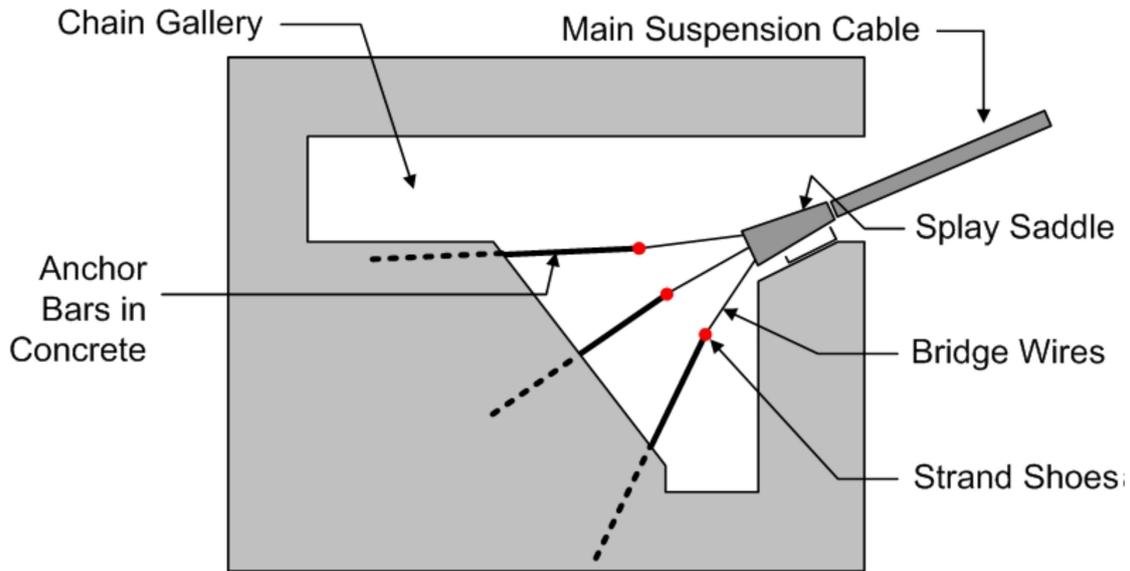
圖 H 主纜索錨定單元(Main Cable Anchorage Elements)
